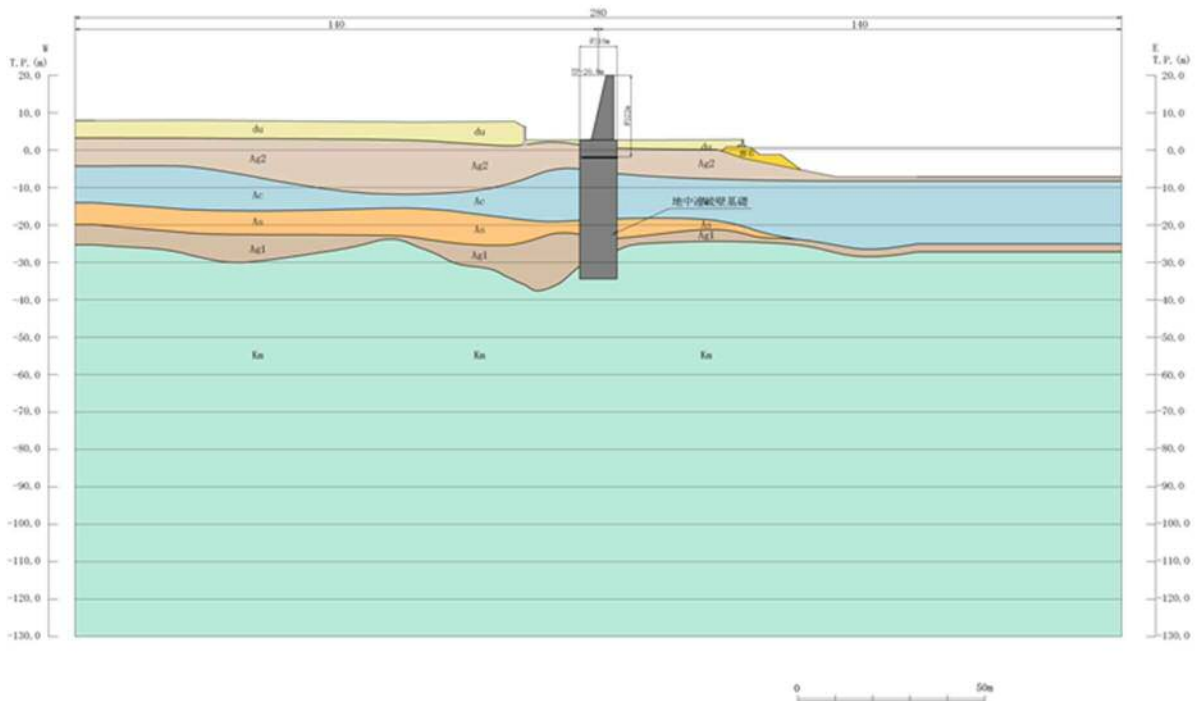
評価対象断面図 (排水系統IV-1)
